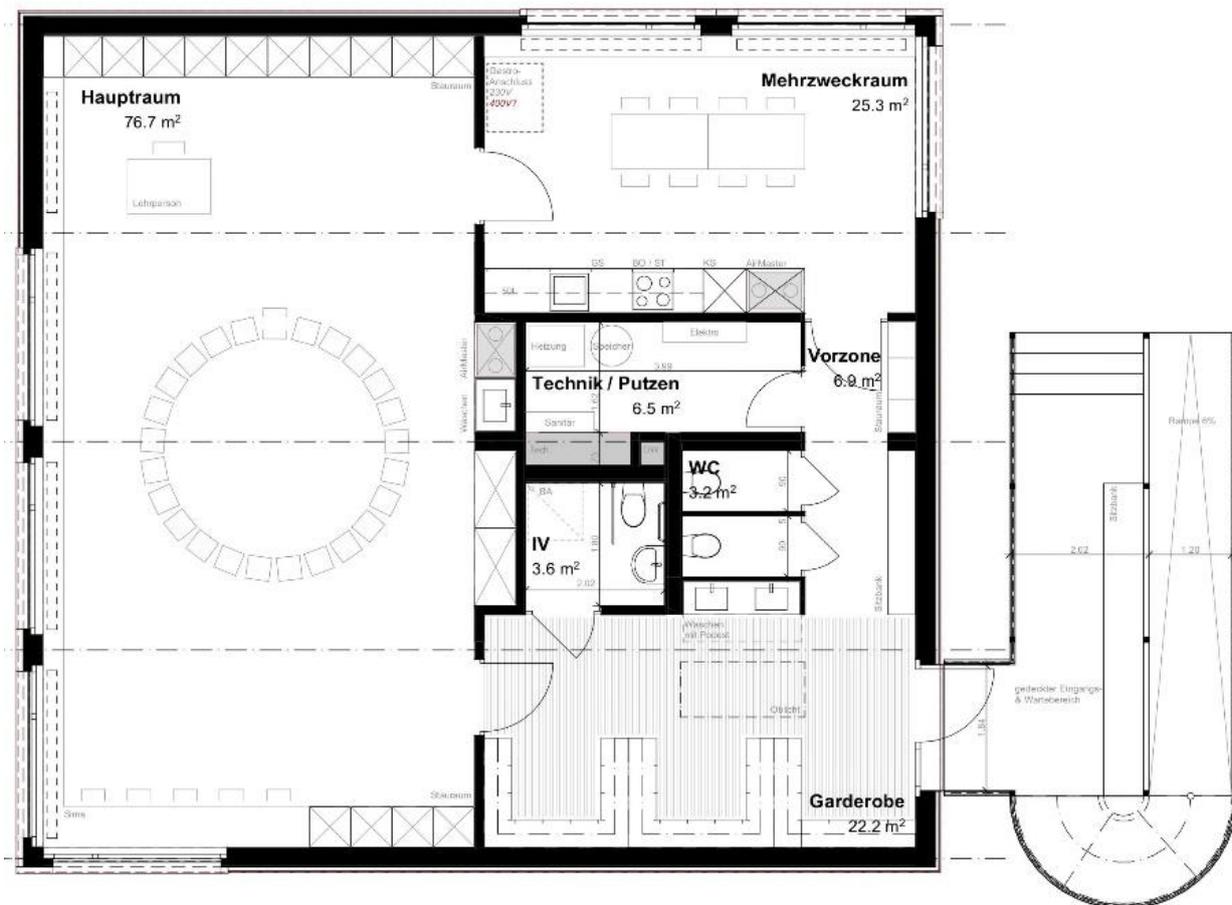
Grundriss einer mobilen Schulraumeinheit
